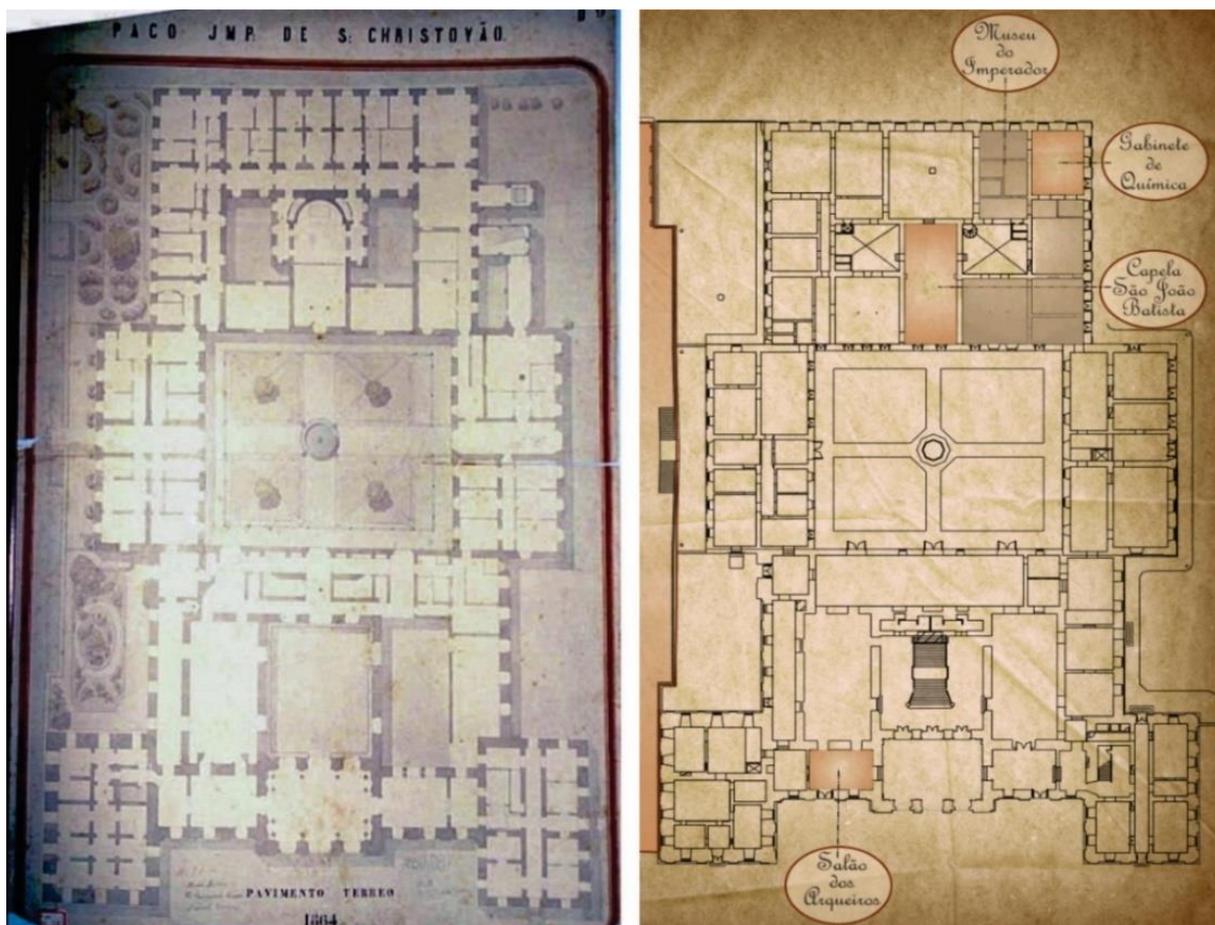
Planta baixa do 1º Pavimento Paço; à esquerda em 1864 e à direita atualmente.
